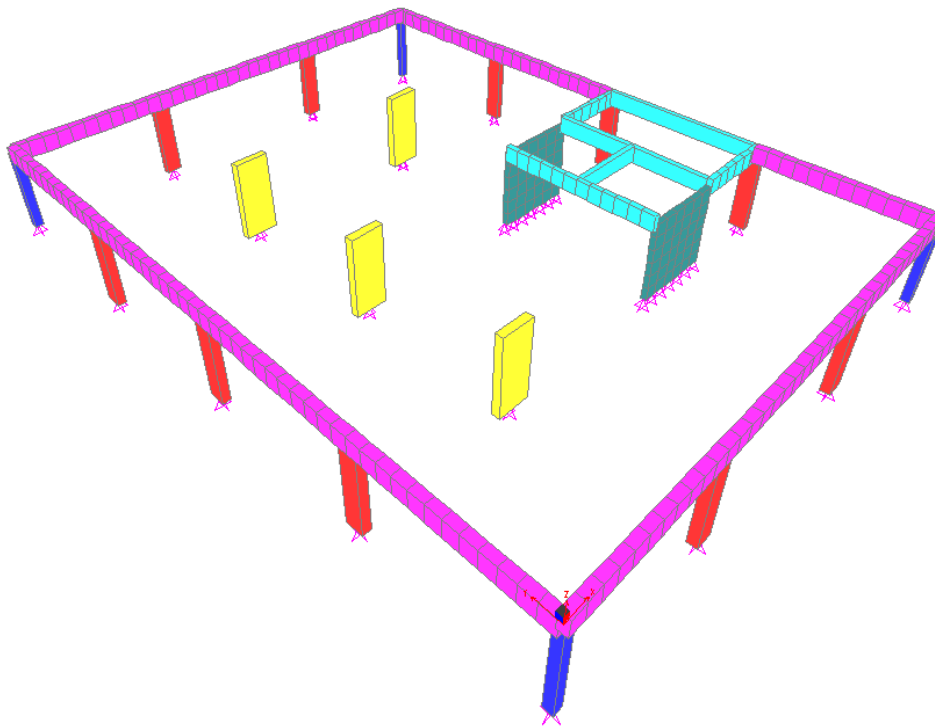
Estrutura do pavimento tipo em 3D sem a laje lisa via SAP2000
